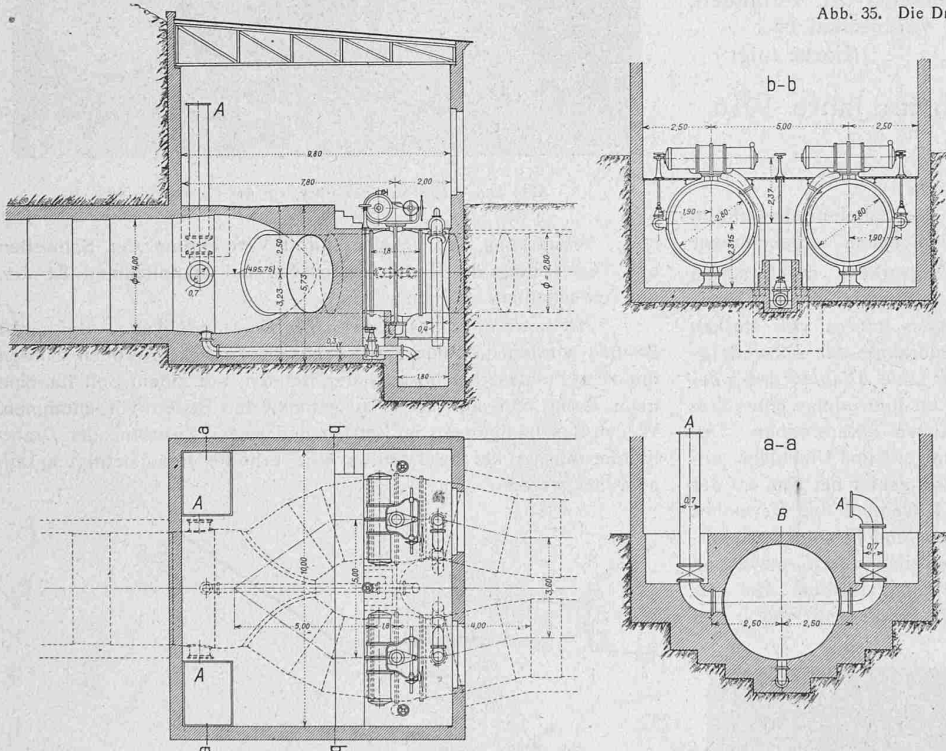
Gabelung der Druckleitung mit Drosselklappen und Rohranschlüssen A der linksufrigen Bewässerung; B Bedienungsboden des Apparatenhauses. — Masstab 1:250.
